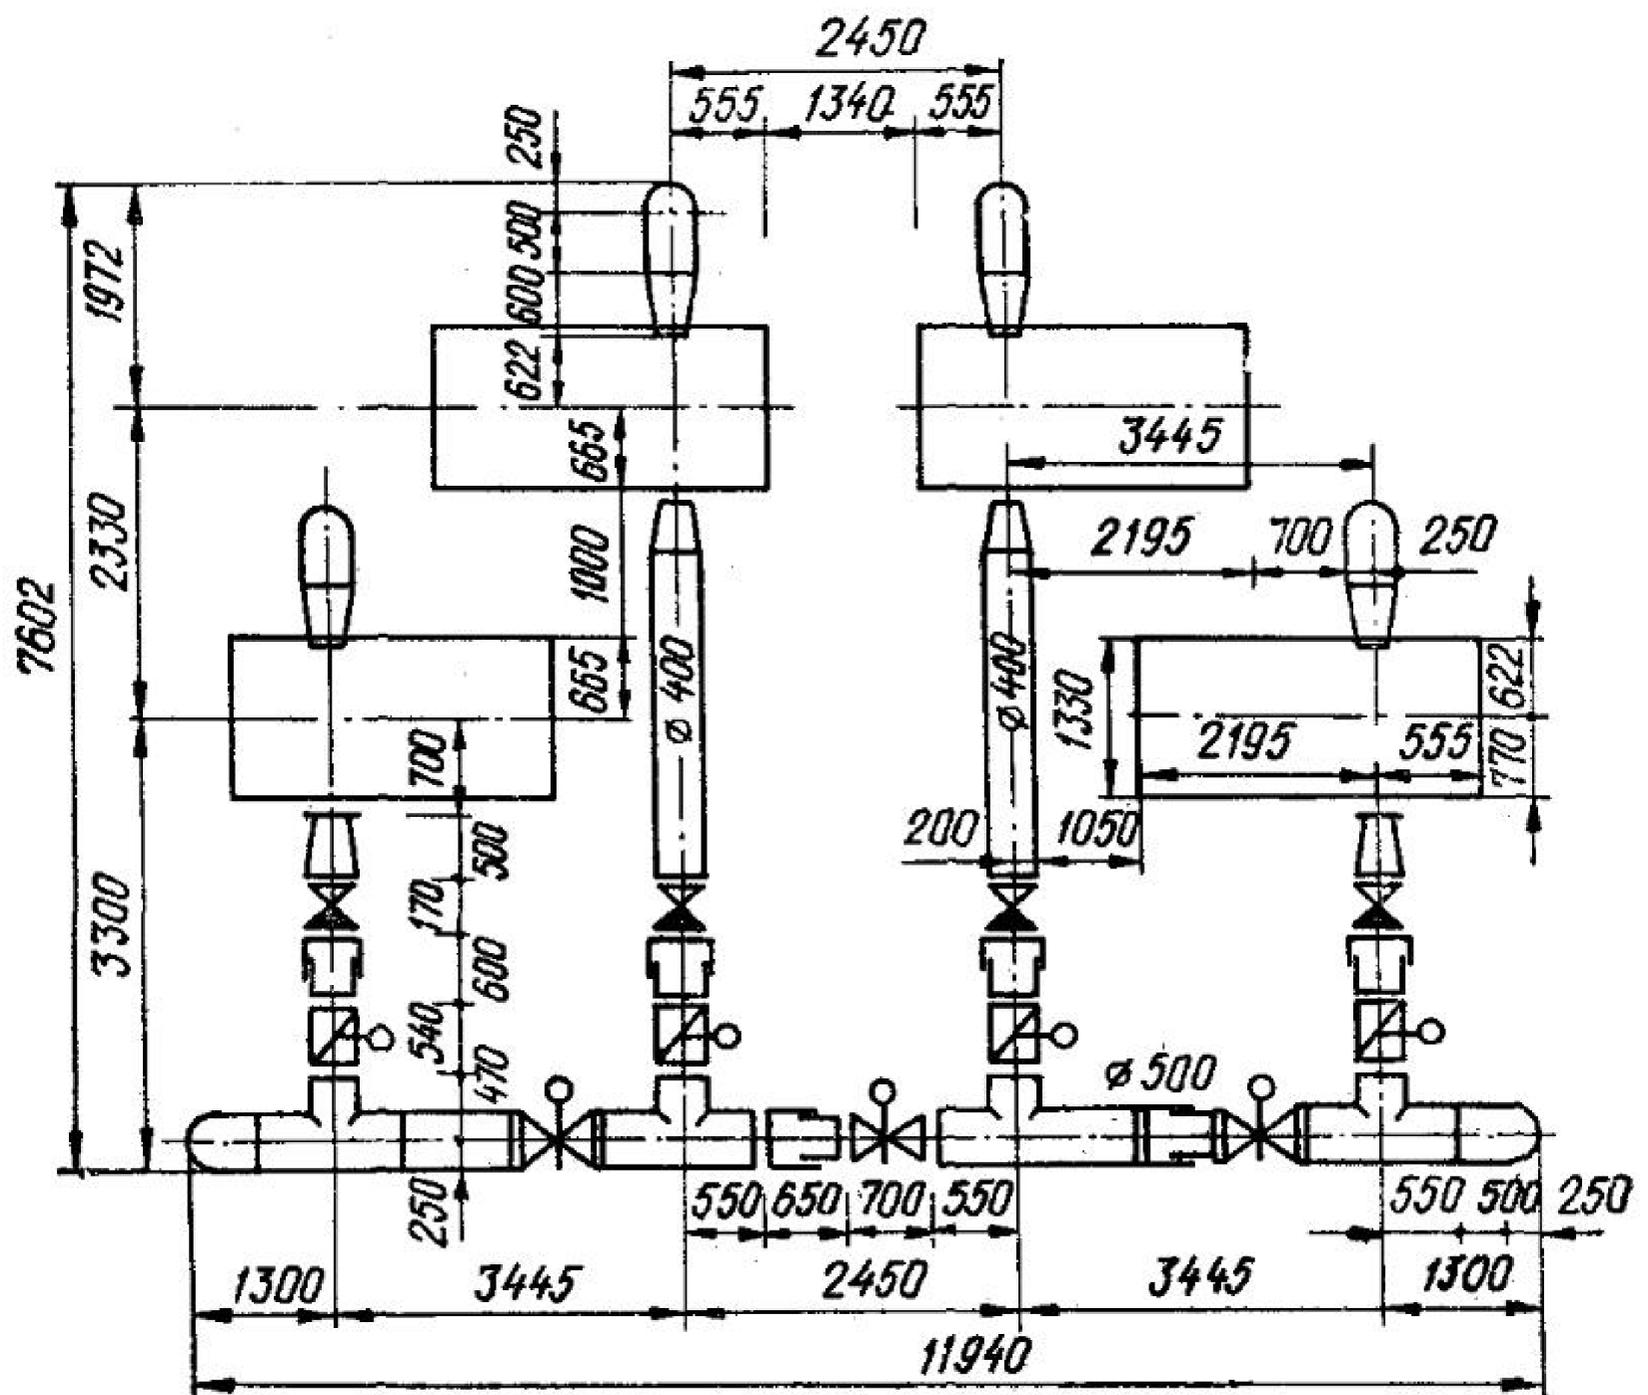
Схема к определению минимальных размеров площадки размещения оборудования в насосной станции
